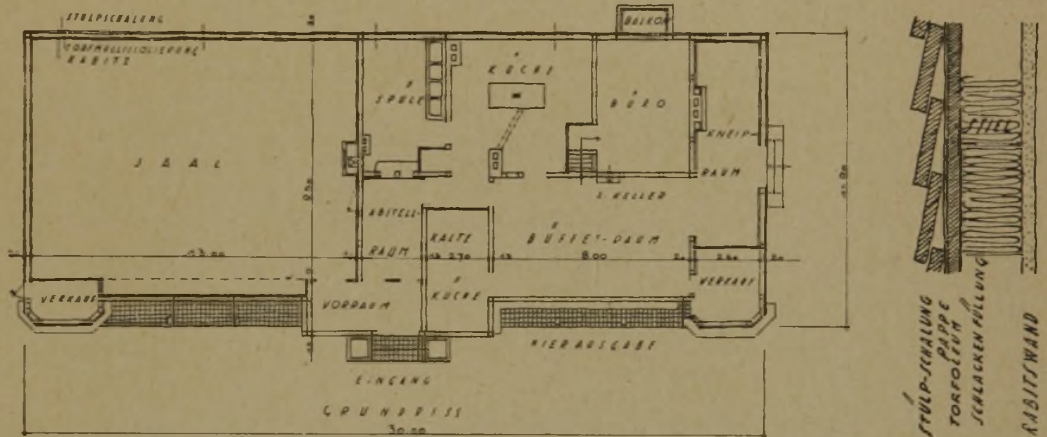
Grundriß des Strandpavillons. (1:300.)
